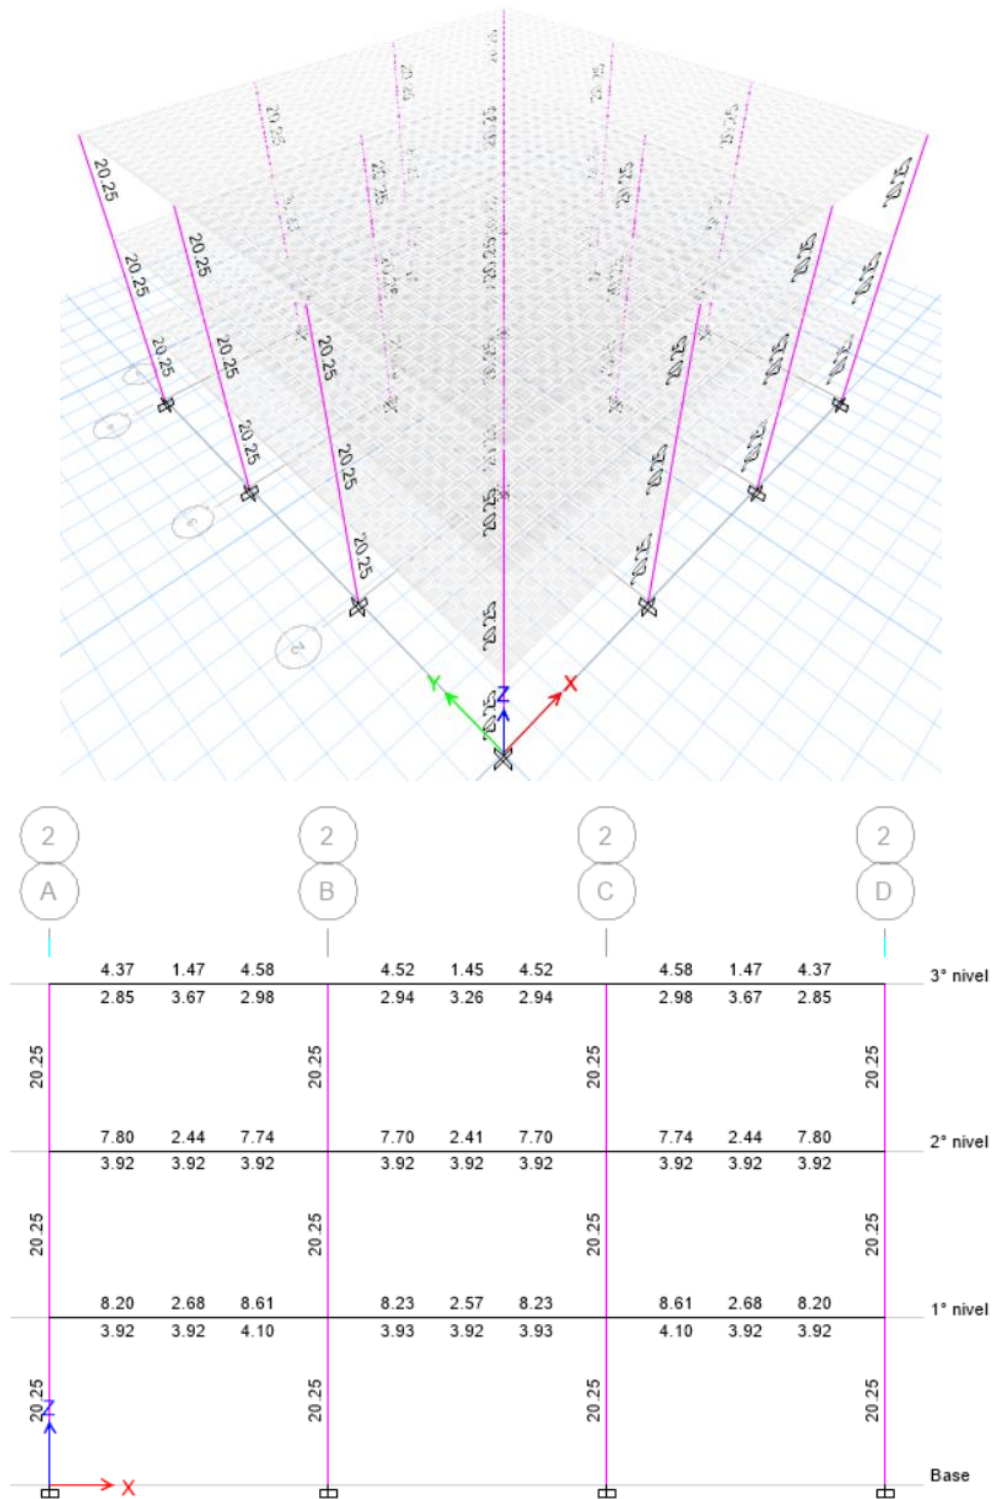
Acero en vigas del 2° y 3° nivel - Estructura 3 niveles en Z4 y S1
